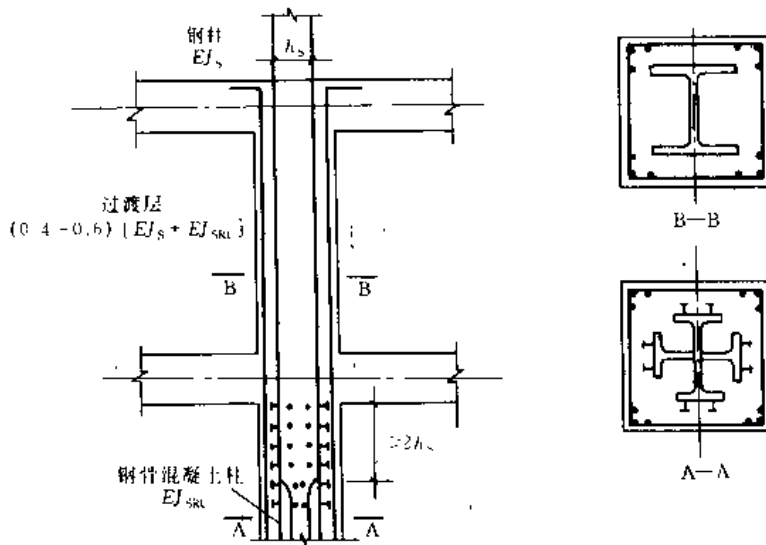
钢骨混凝土柱与钢柱连接的过渡层构造
